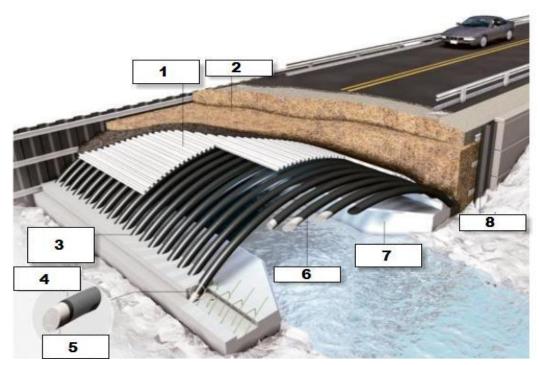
Арочный мост с несущими элементами из заполненных бетоном арок из композитного материала: 1 - гофрированные листы из композитного материала; 2 - грунтовая засыпка; 3 — концы труб, заделанные в бетонный фундамент; 4 - композитная оболочка трубчатой арки; 5 — бетонное ядро; 6 — арки; 7 — бетонный фундамент; 8 — оголовок [4]
